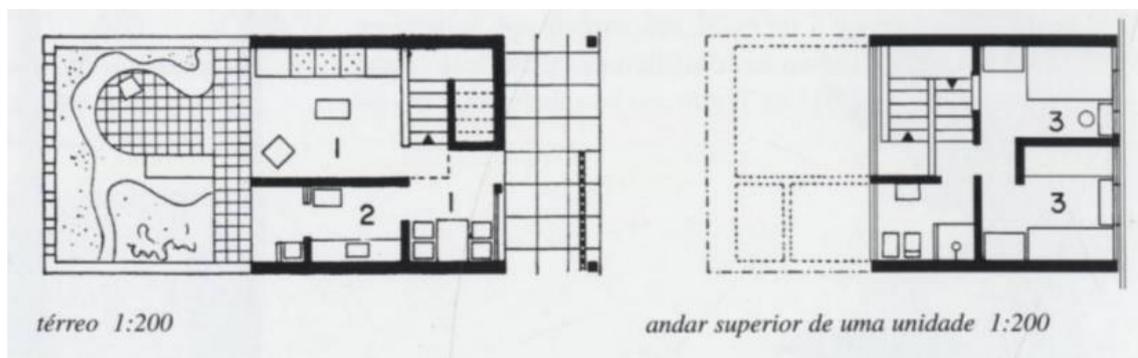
Planta-baixa pavimento térreo e superior das unidades habitacionais do Conjunto Residencial de Paquetá, projeto de Francisco Bolonha enquanto no DHP.
